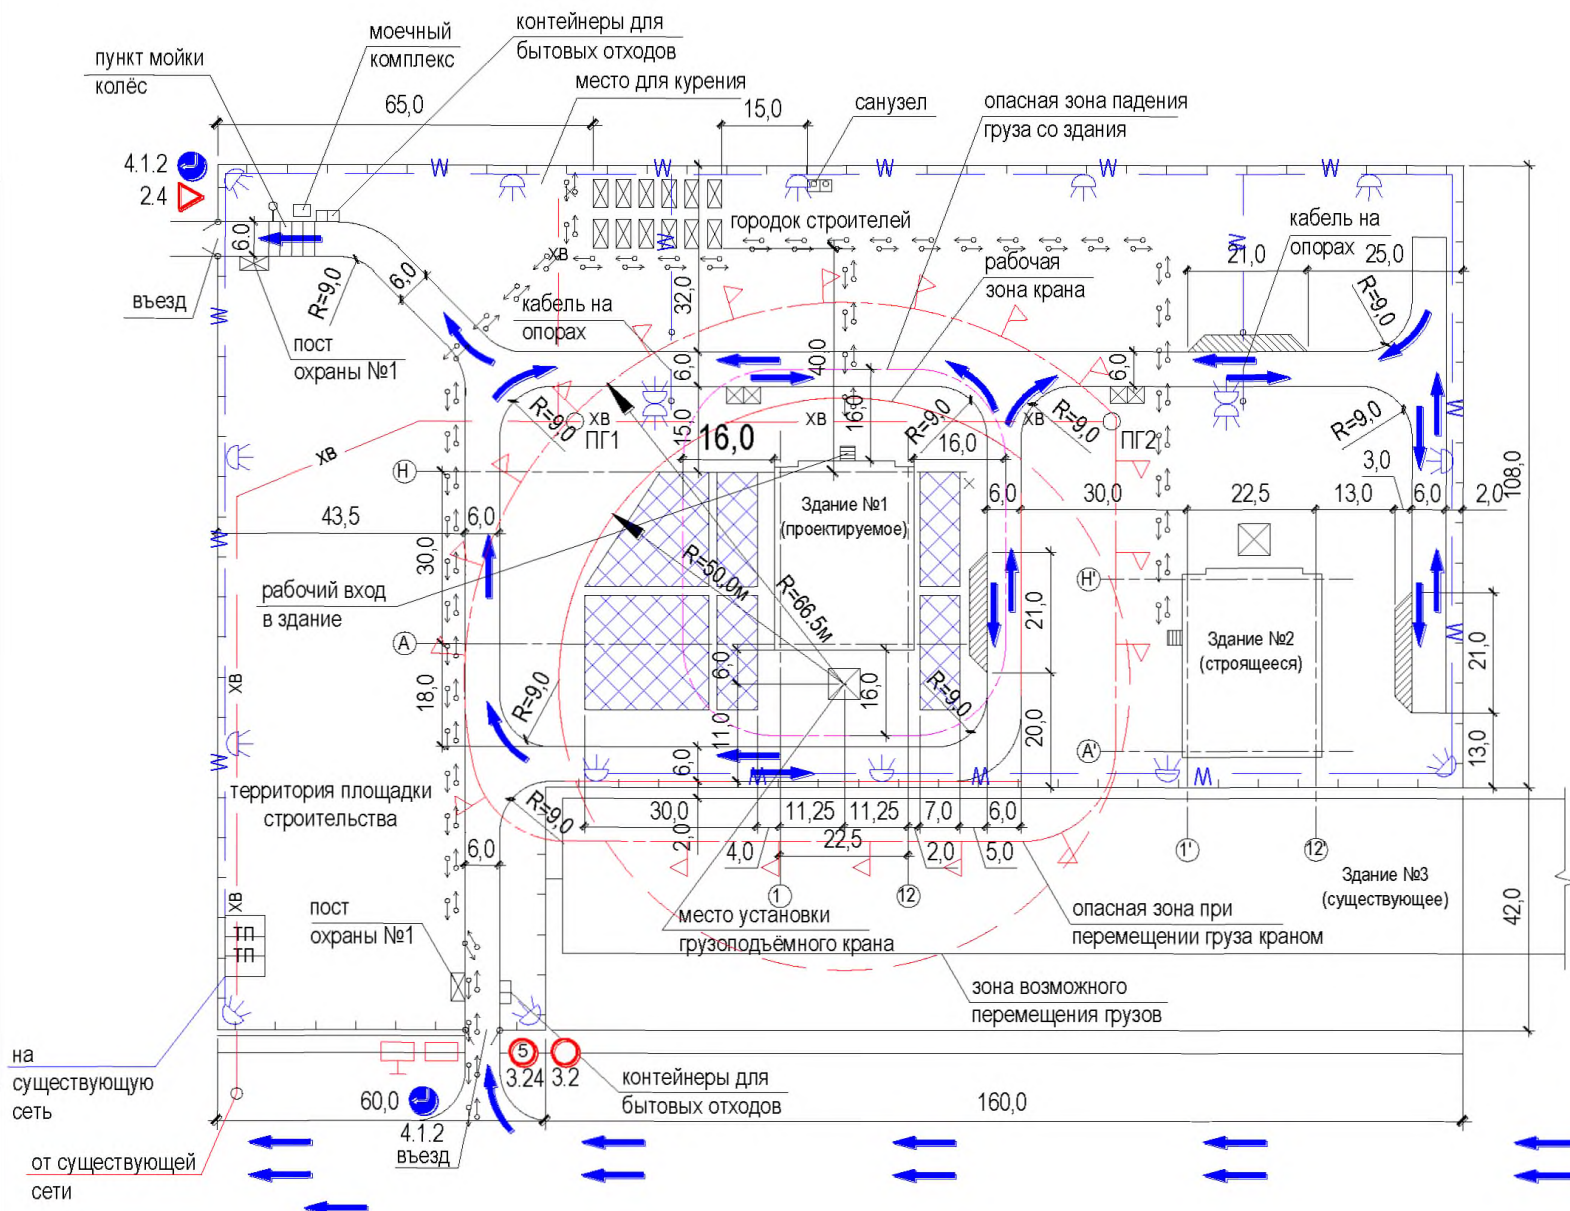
Схема сетей временного водоснабжения строительной площадки
